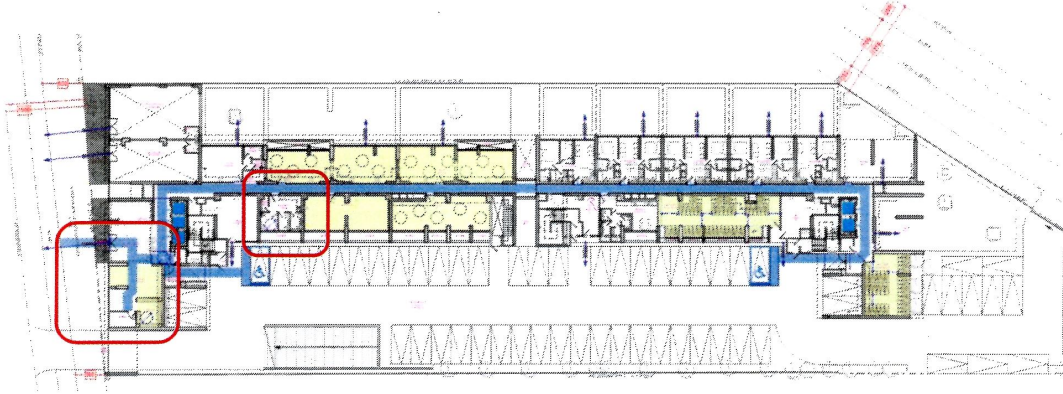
planta piso 1 con ruta de accesibilidad universal
